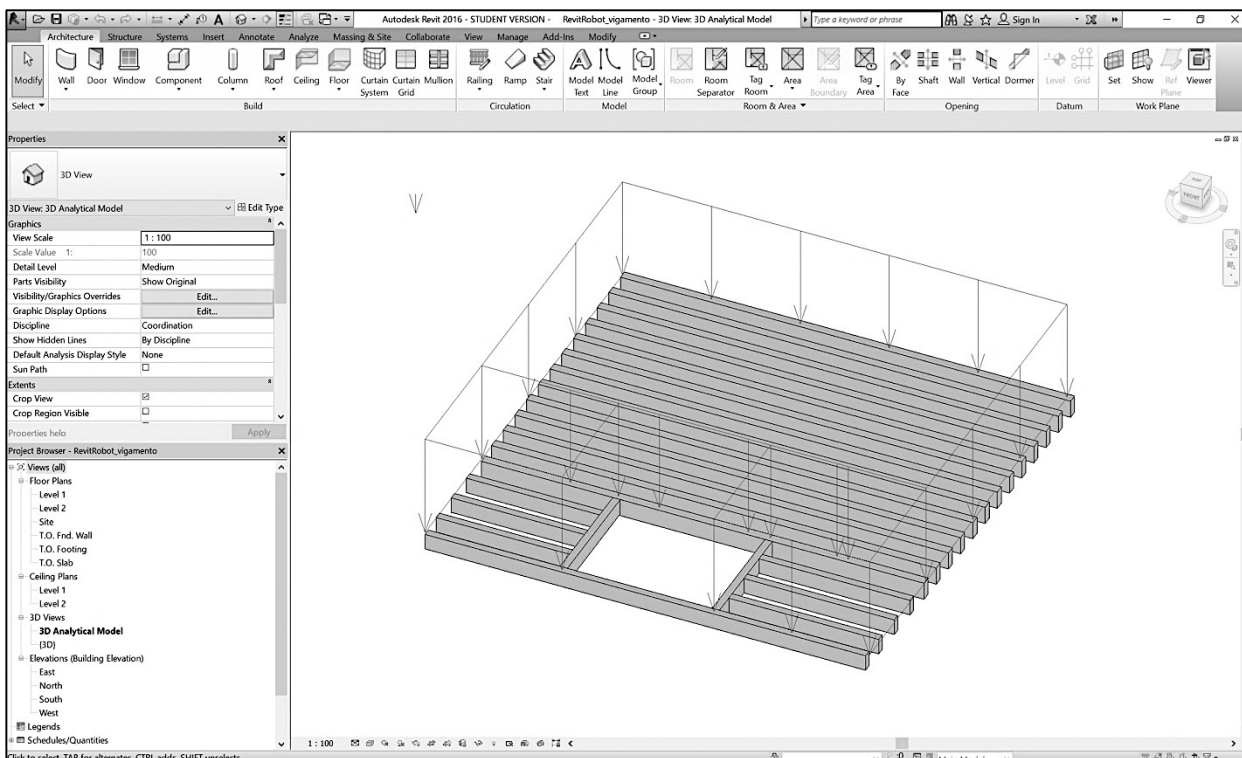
Revit. Pavimento de madeira com vigas em secção retangular. Teste de interoperabilidade.
